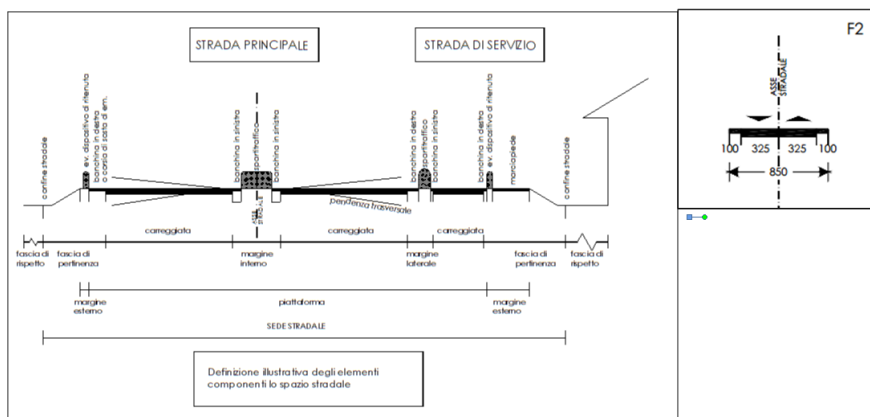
DEFINIZIONE ILLUSTRATIVA DEGLI ELEMENTI COMPONENTI LO SPAZIO STRADALE
